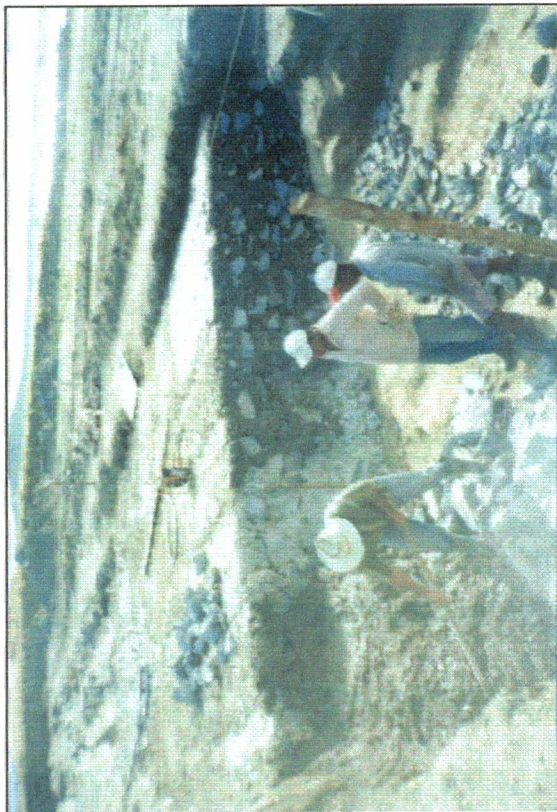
Preenchimento de depressão na área do sangradouro com concreto ciclópico.
